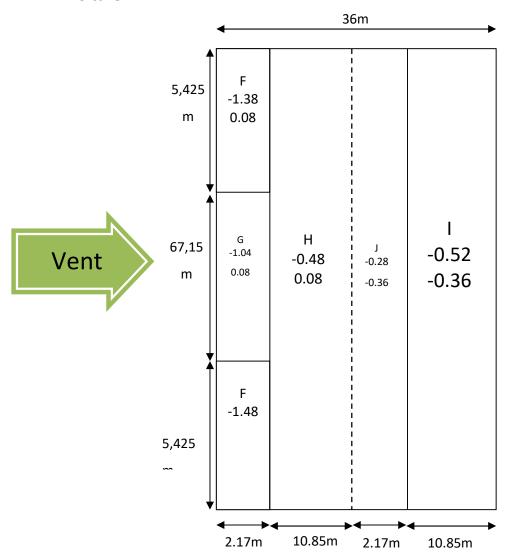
Cpe pour toiture de (Vent sur long-pan).
